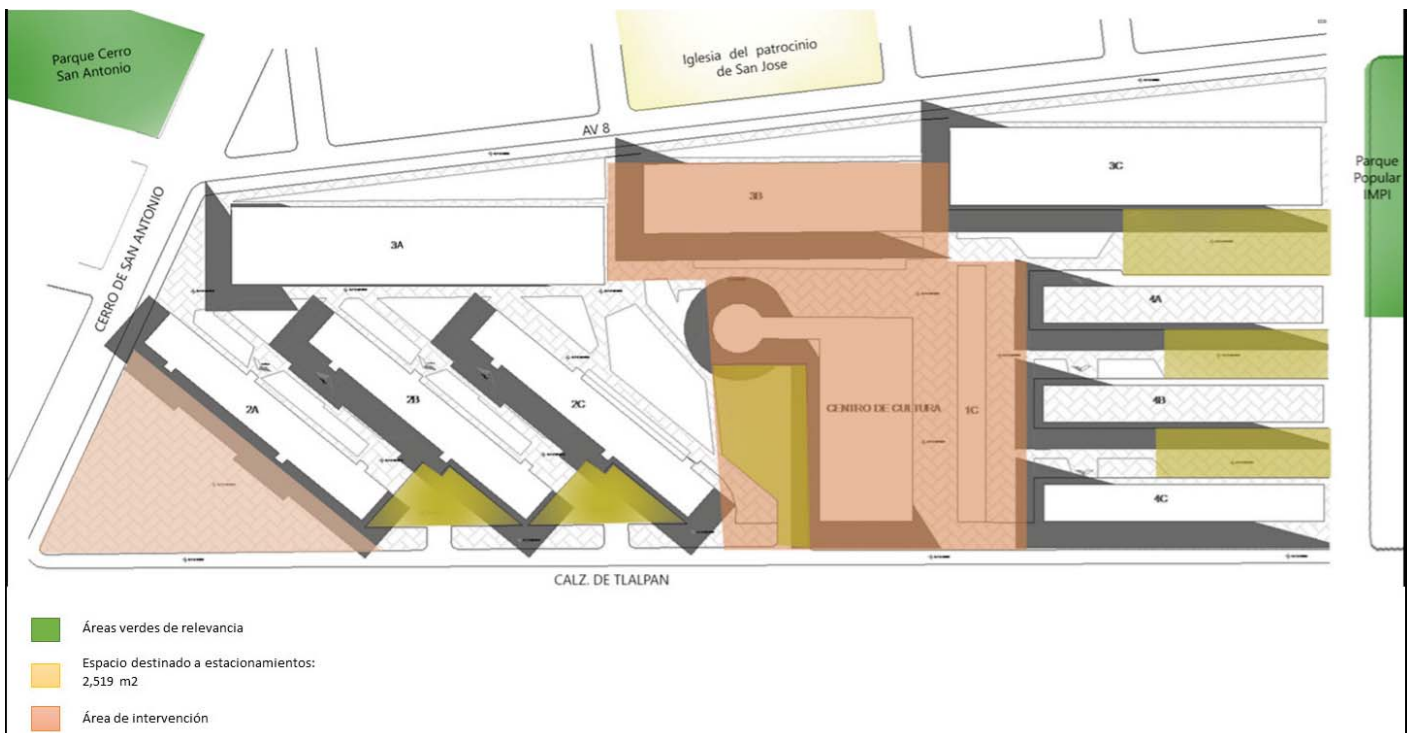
Áreas de intervención dentro del conjunto. Elaboración propia
